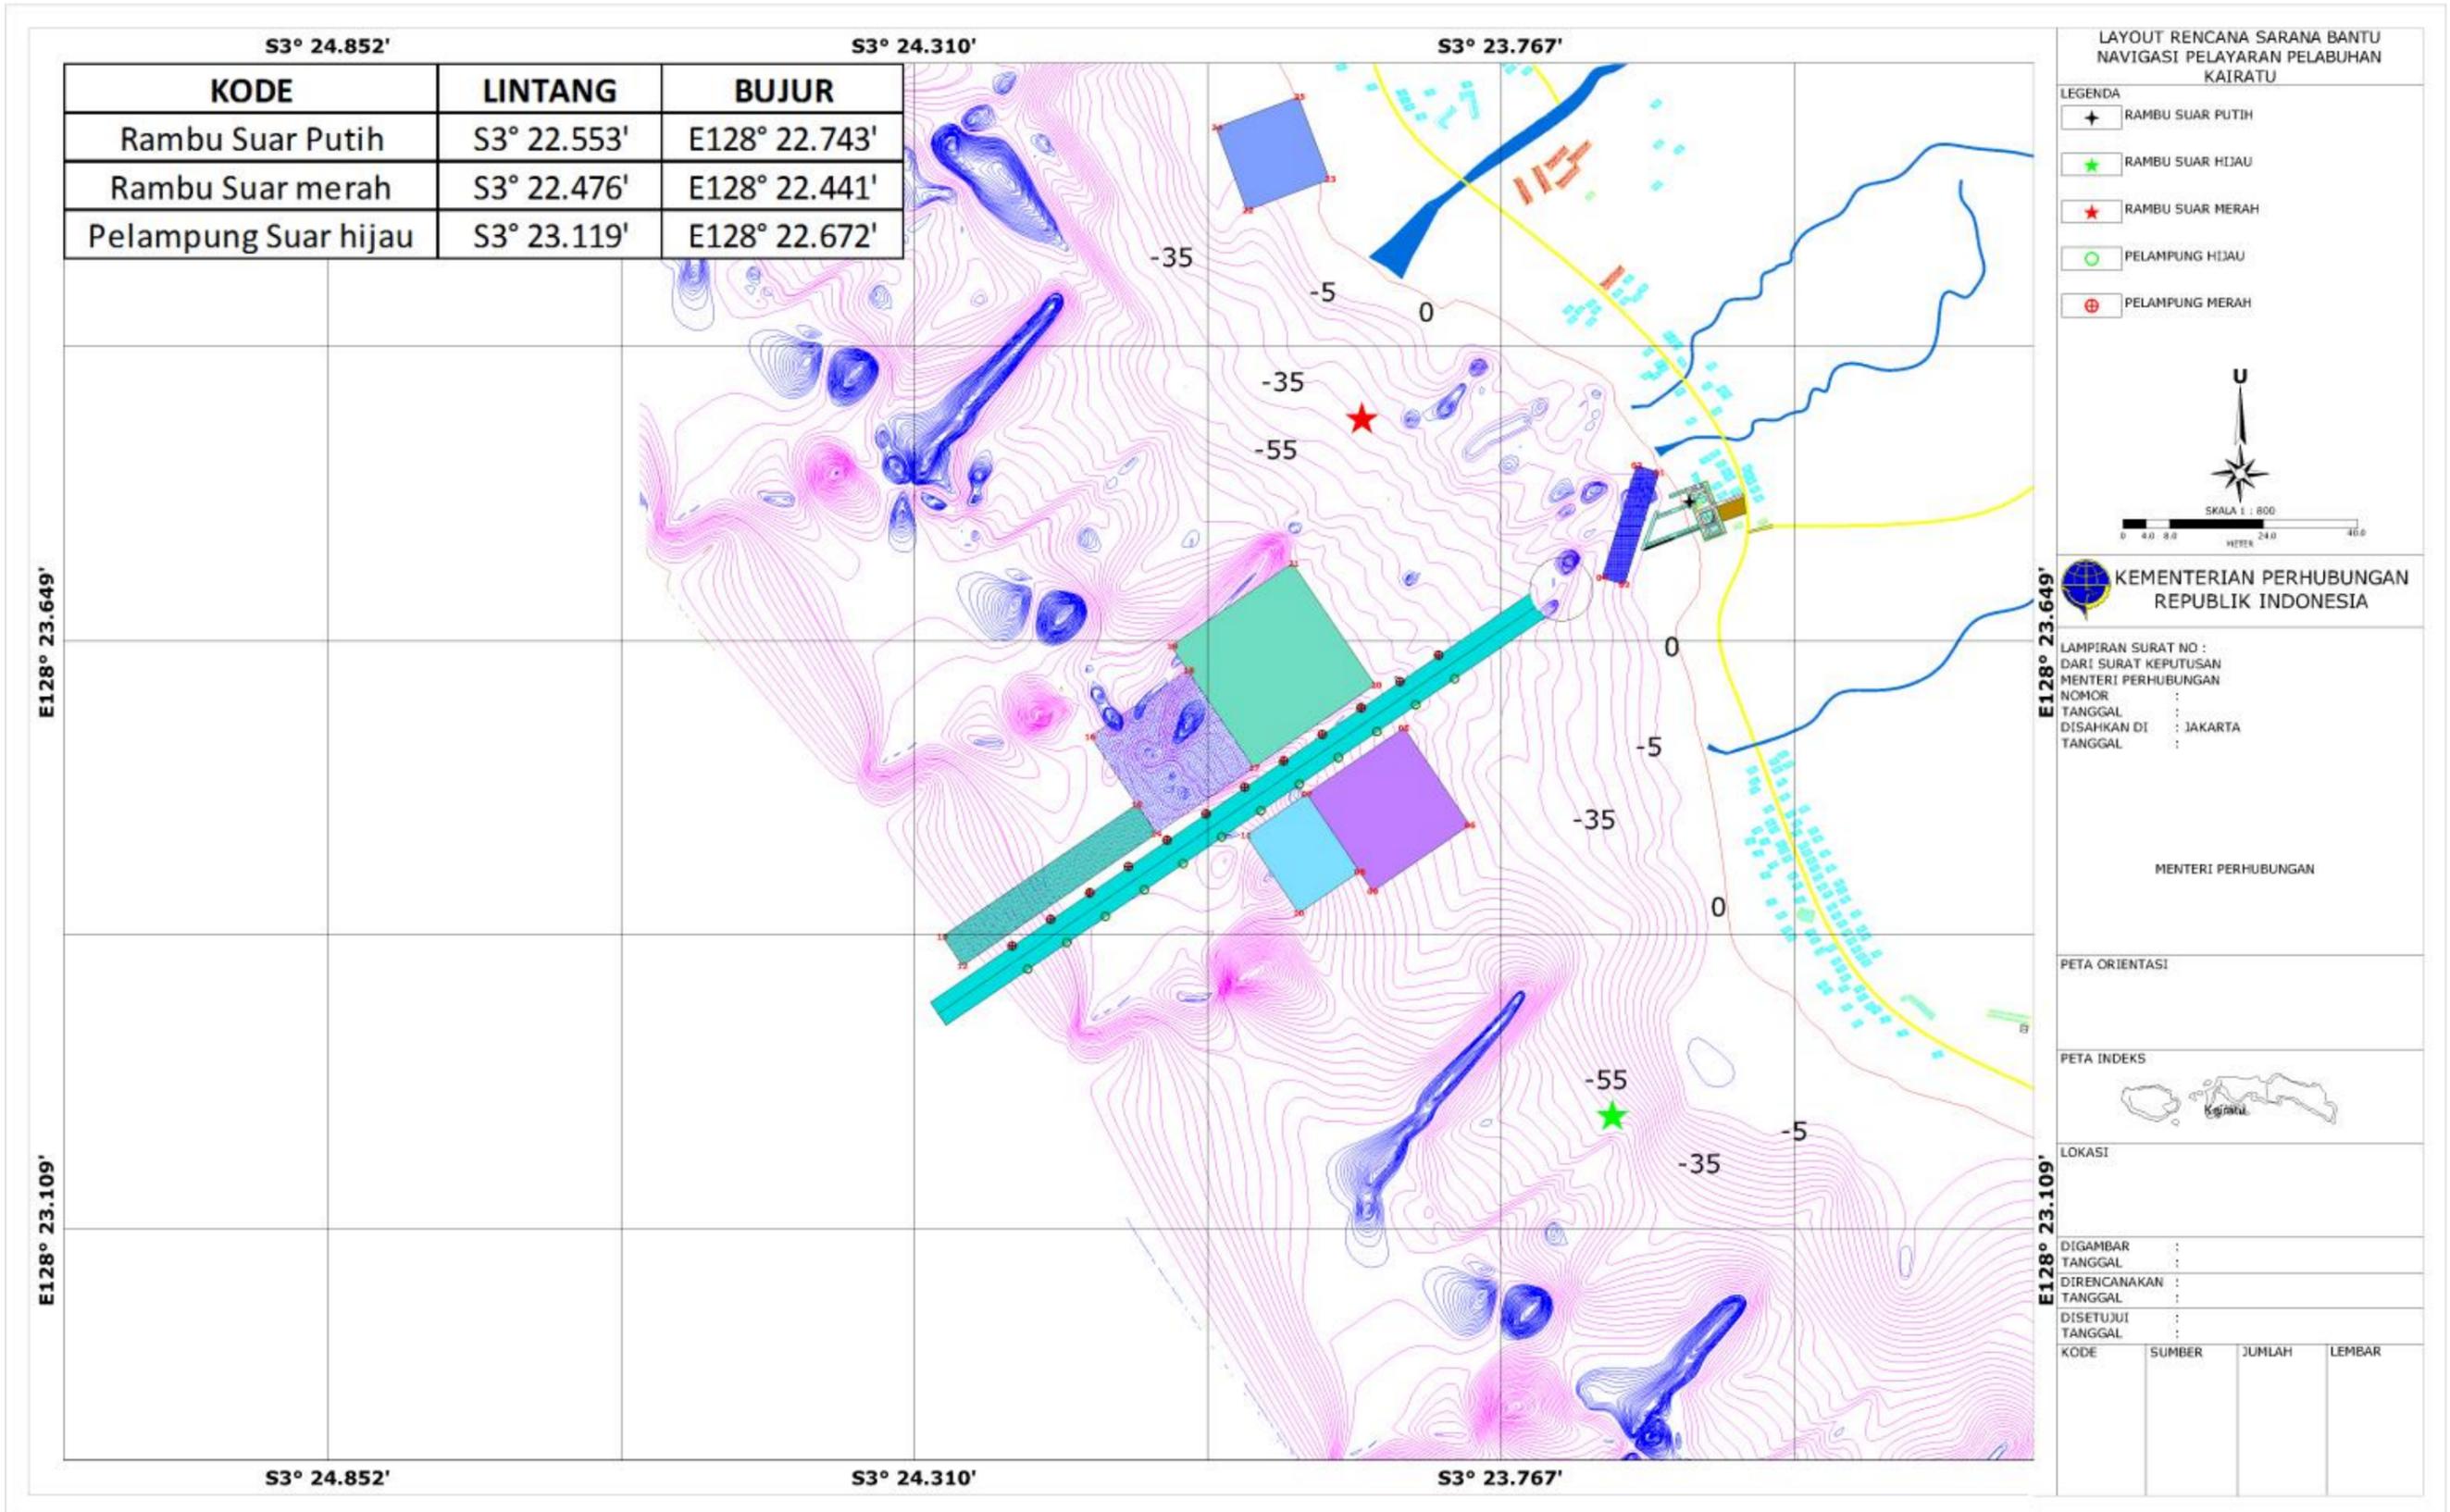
Layout Rencana Jangka Panjang Pelabuhan Kairatu
